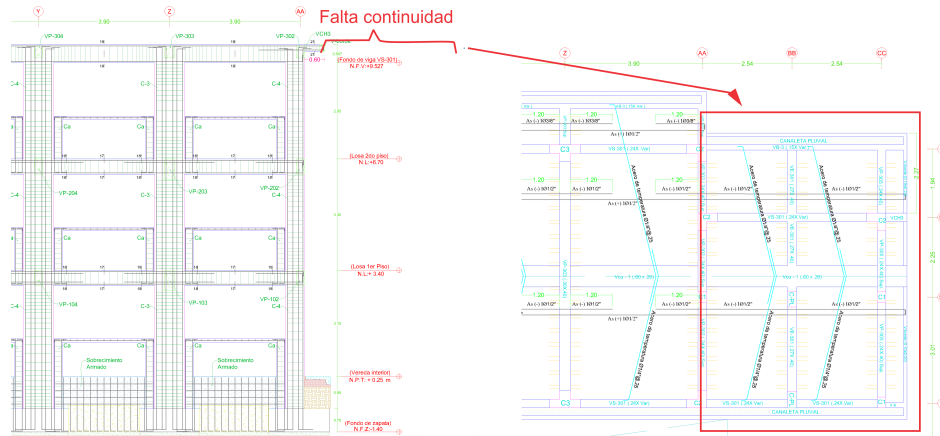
Falta de sincronía entre plano en corte con el plano en planta-Bloque 1. *Fuente: Elaboración propia.
